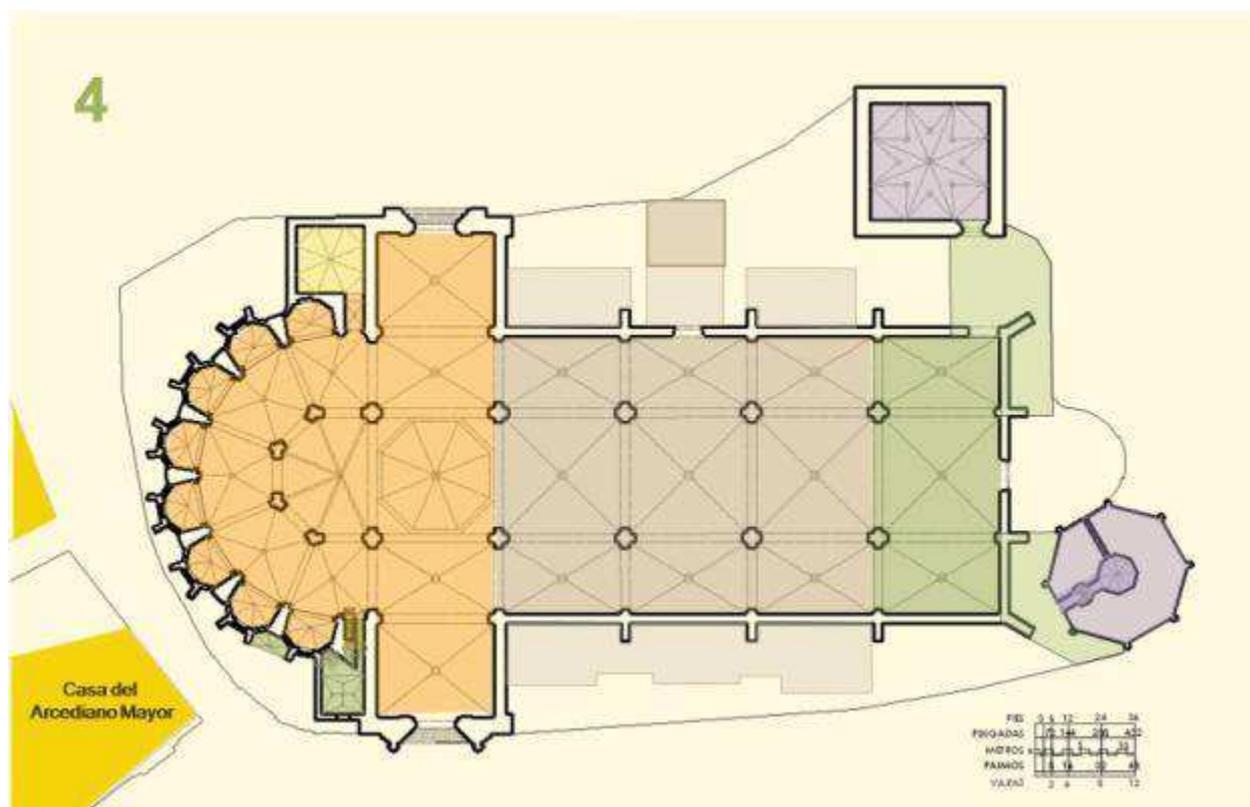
12.4 Evolución constructiva. Fase 4 / Planta <sup>307</sup>
